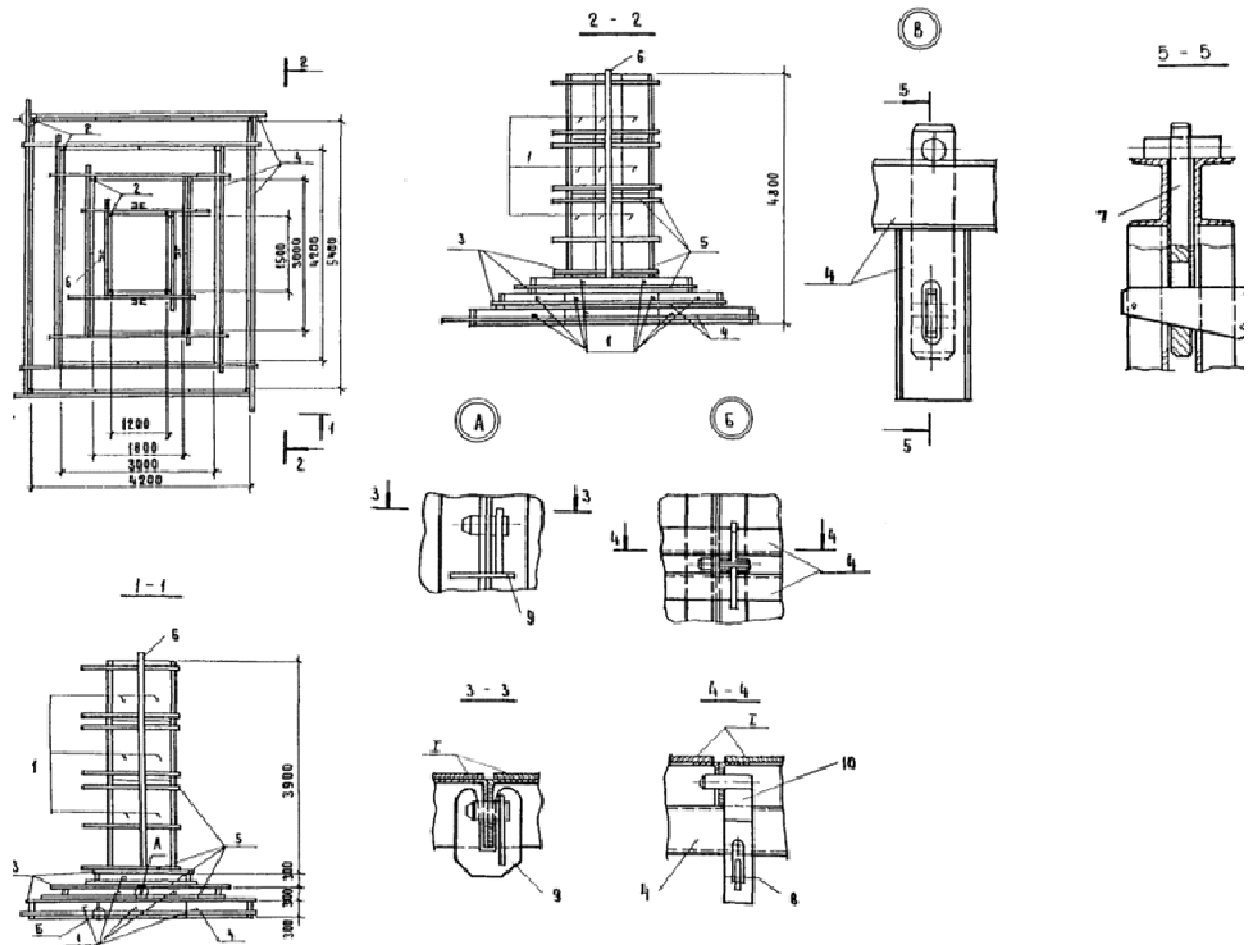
схема конструкції опалубки фундаменту під колону
